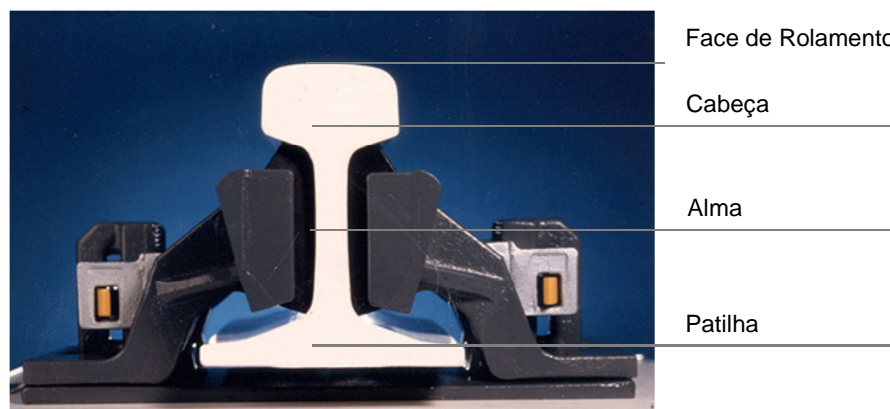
Carril Vignole [adaptado de Paixão e Fortunato, 2009]
